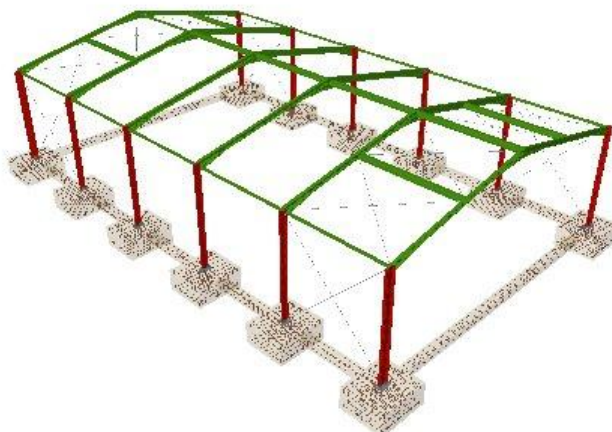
Vista 3D de la estructura y cimentación de la nave
